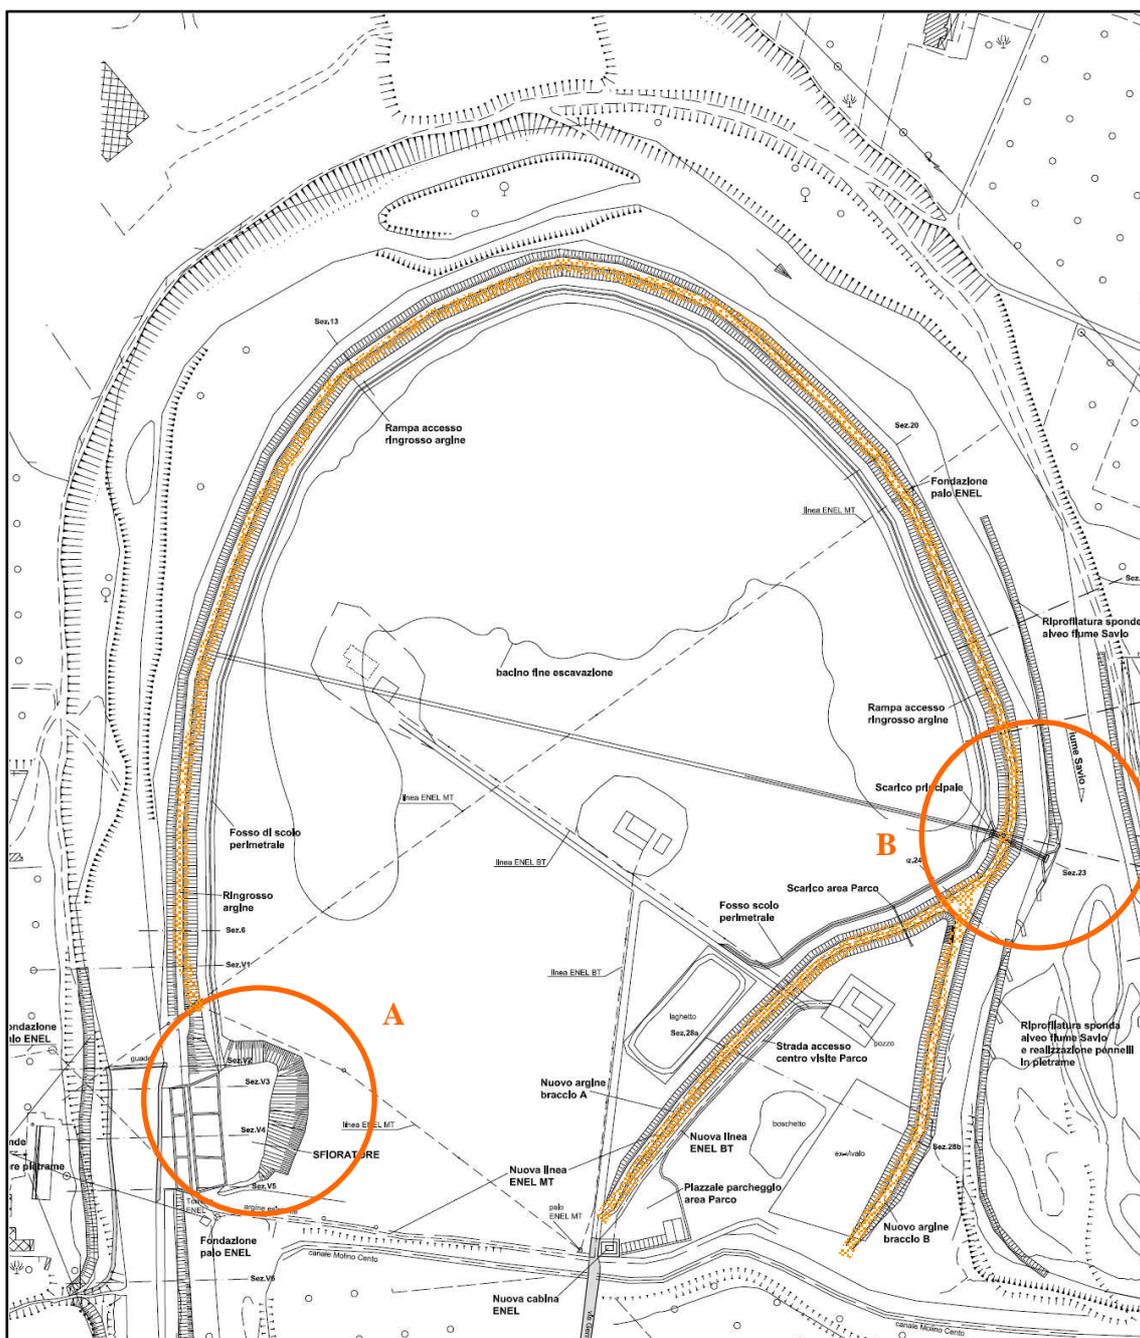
Planimetria generale lavori di realizzazione cassa di laminazione del fiume Savio in località Cà Bianchi.
